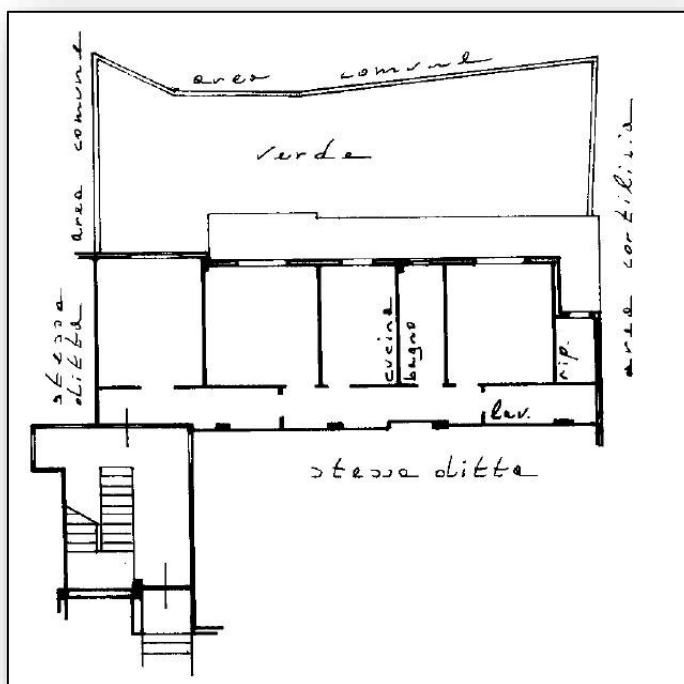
Planimetria Catastale u.i. – dati catastali in atti – piano rialzato
